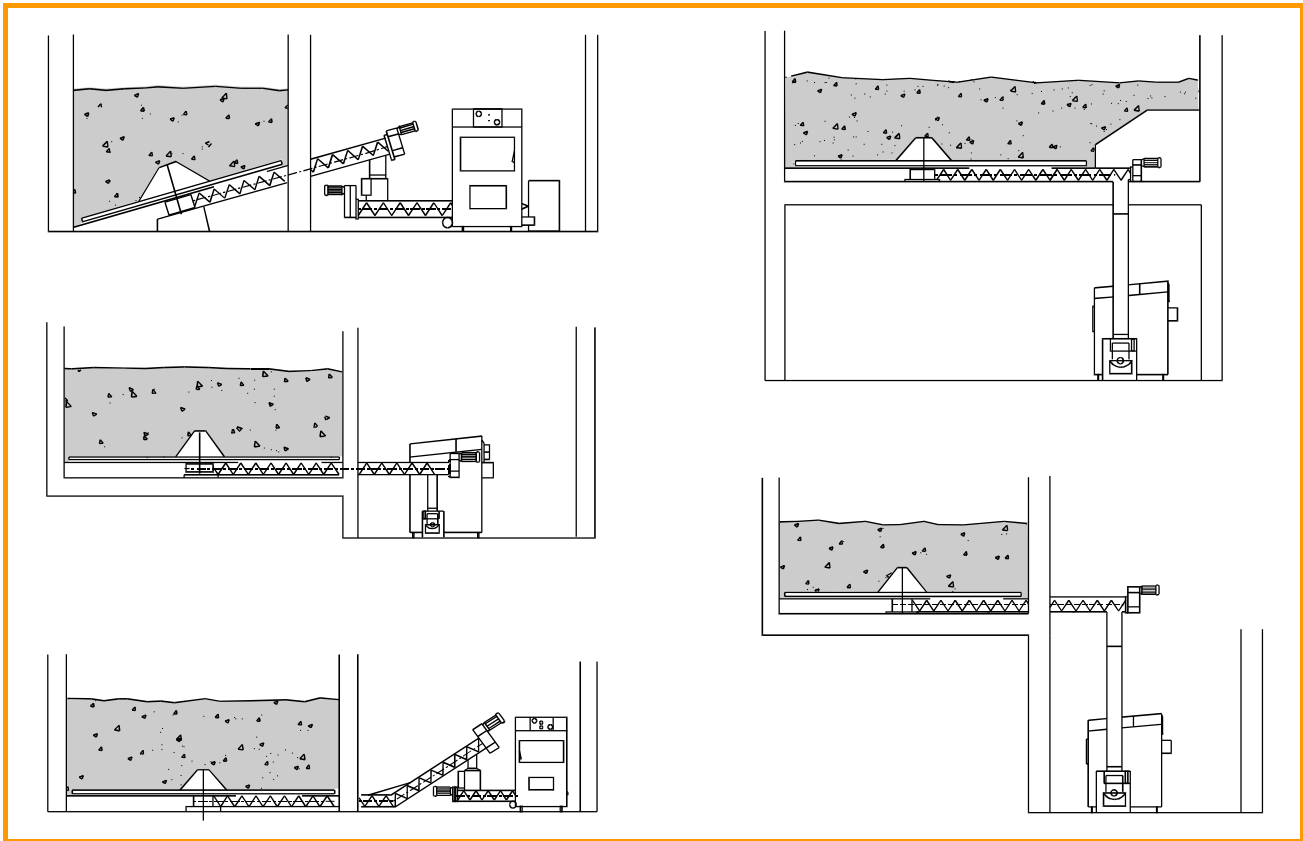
Einbaubeispiele für Hackschnitzelfeuerungen mit Raumaustragsystem in der Ausführung als Blattfederrührwerk und Schneckenförderung (nach I6-30/)
